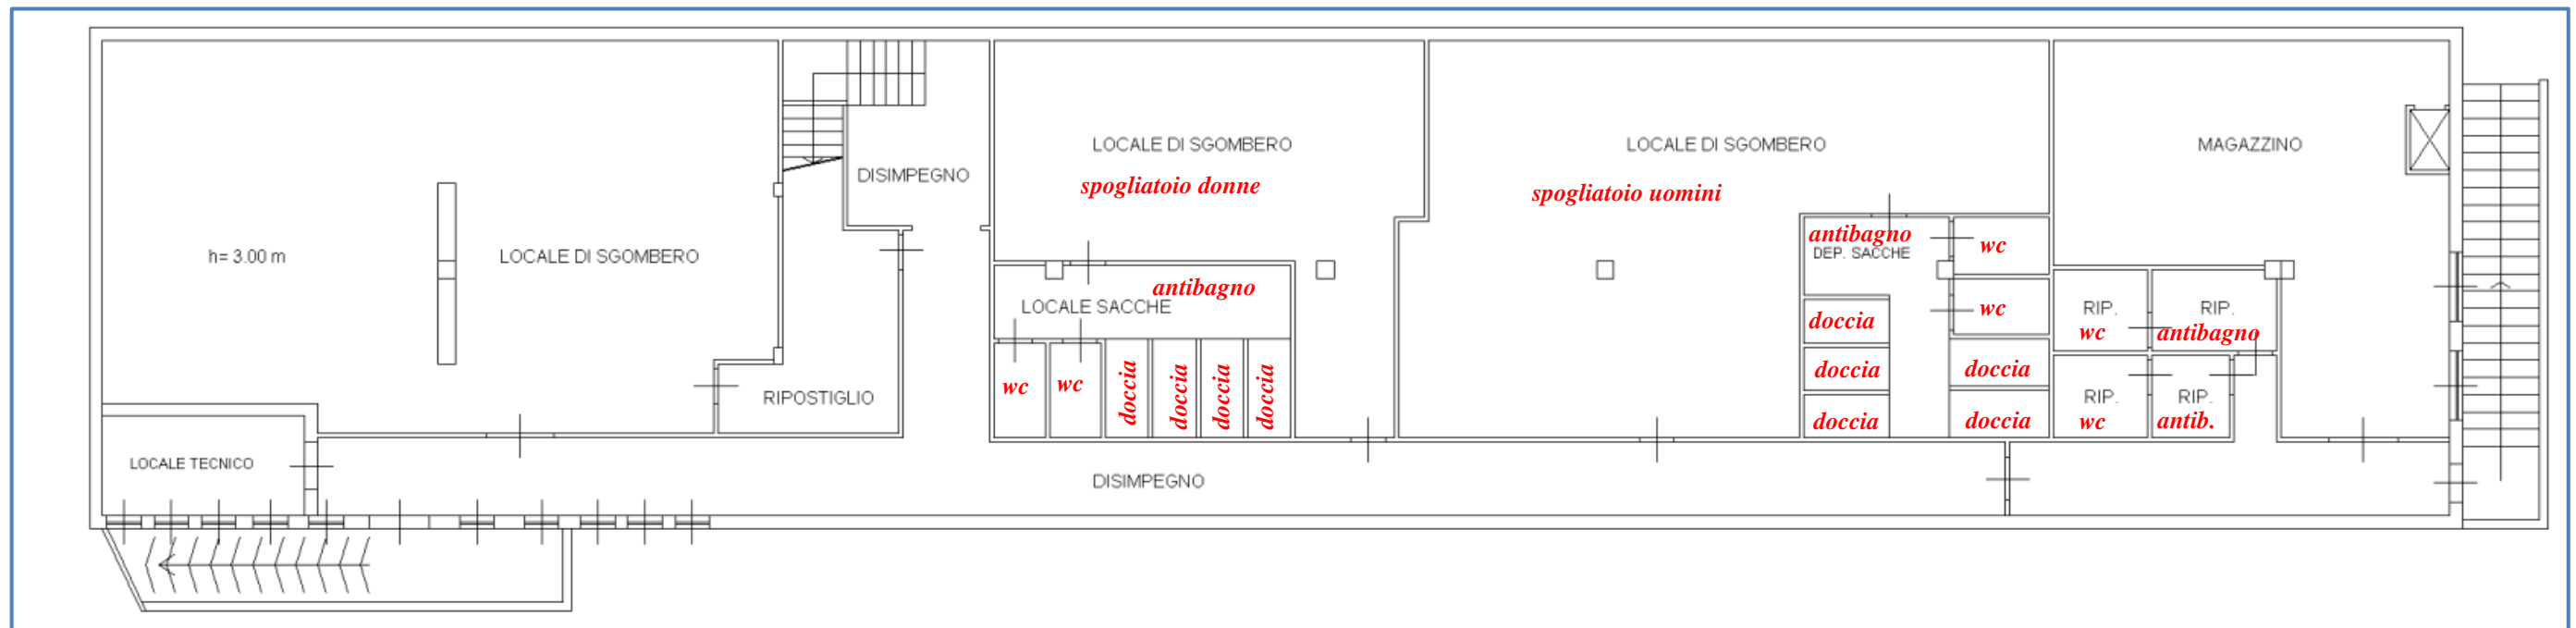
estratto della planimetria catastale particella FG.16 M.758 S.1
